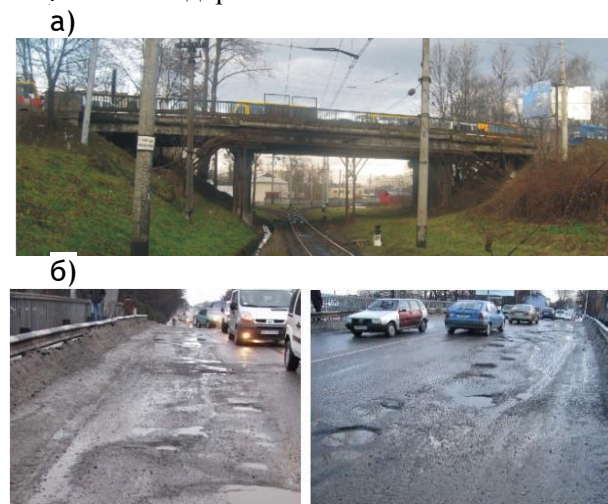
Загальний вид існуючого шляхопроводу (а) та вид на мостове полотно (б)
